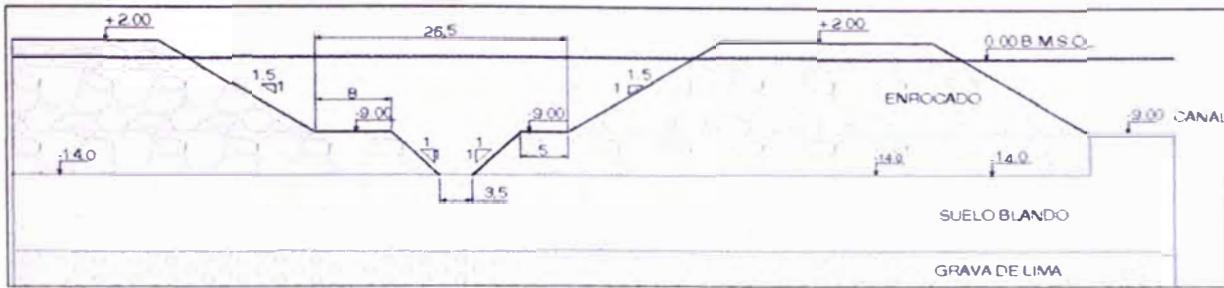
Excavación de la segunda zanja y retiro de enrocado
